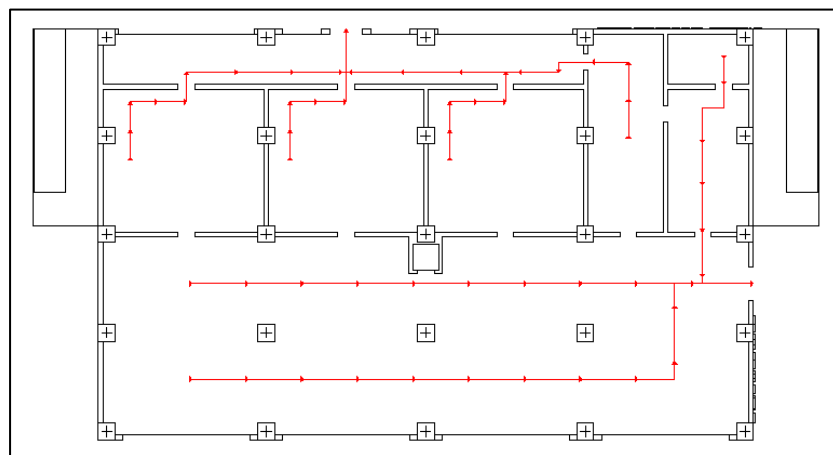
Esquema planta baja, detalle recorrido de evacuación en rojo.
